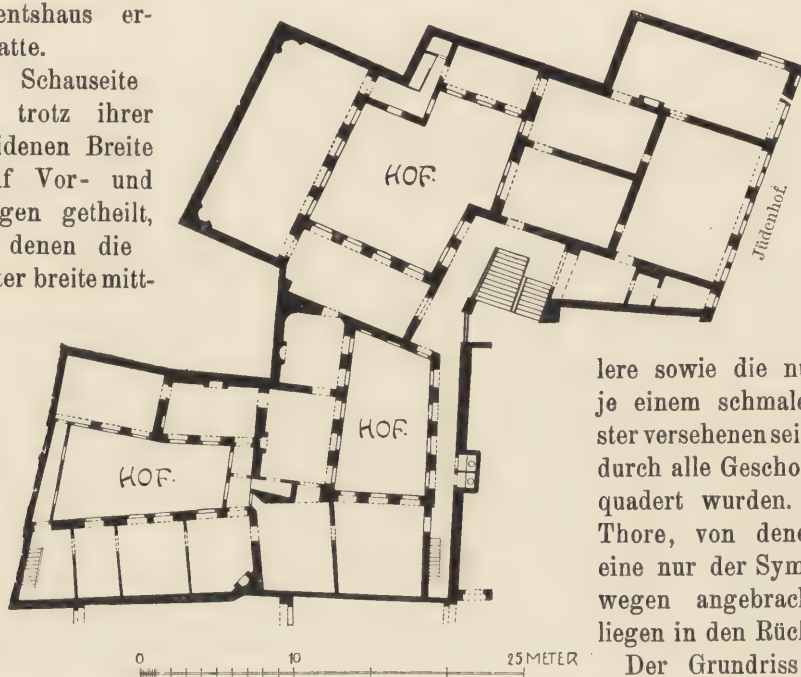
Regimentshaus, Grundriss des Hauptgeschosses.
